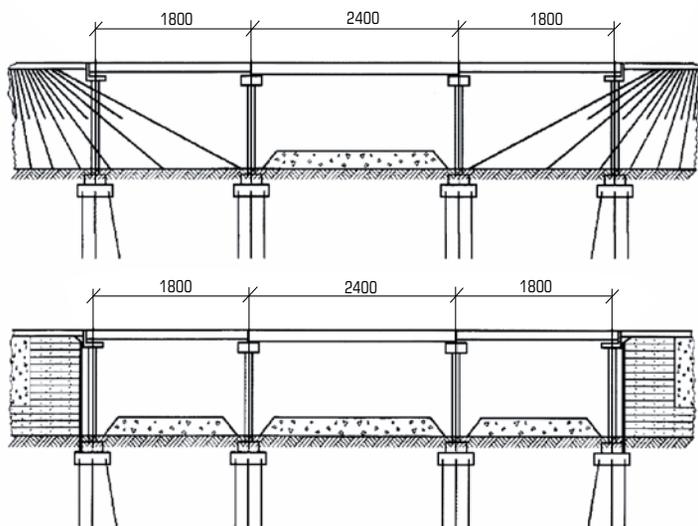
Реконструкция трехпролетного путепровода путем устройства армированных систем и дополнительных полос движения
